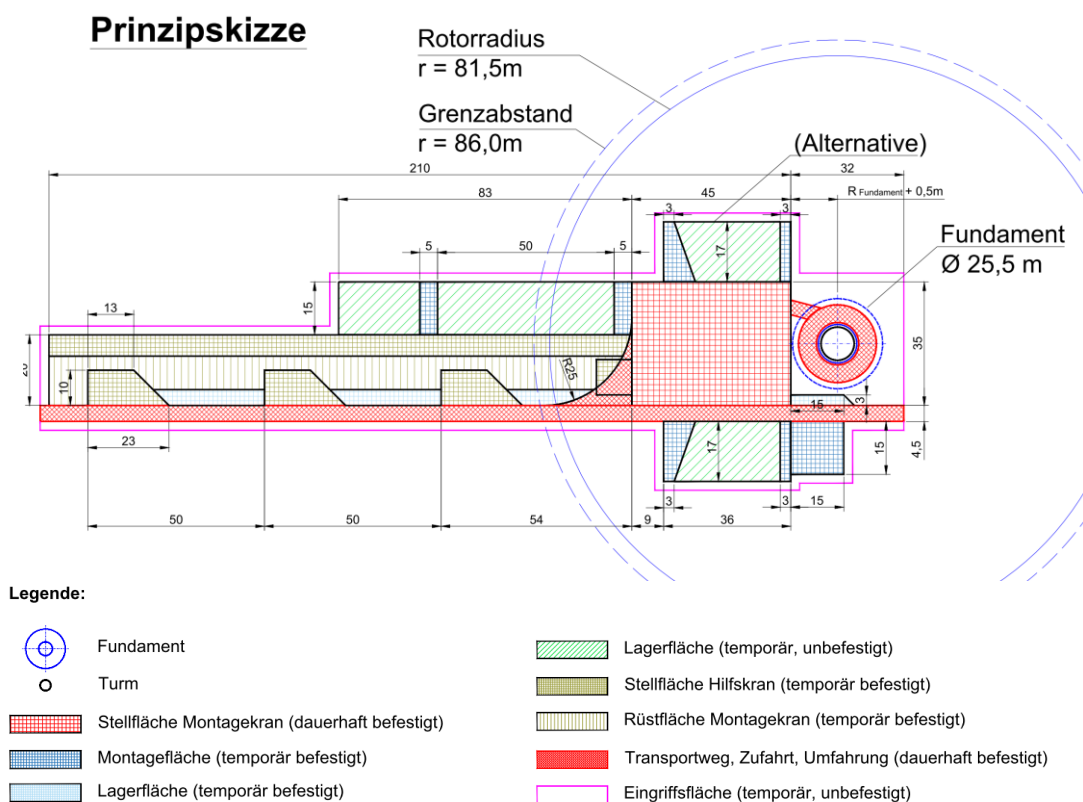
Planskizze der einzelnen Bauflächen pro Standort
